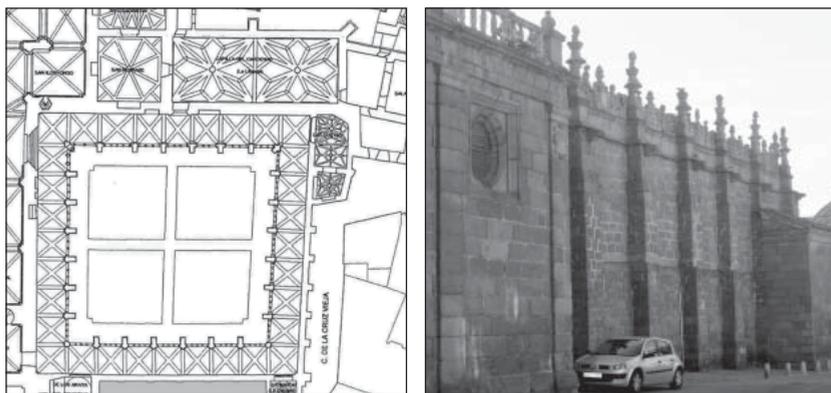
Planta del claustro señalando el lugar que ocuparía la trastera y vista exterior de su localización.
